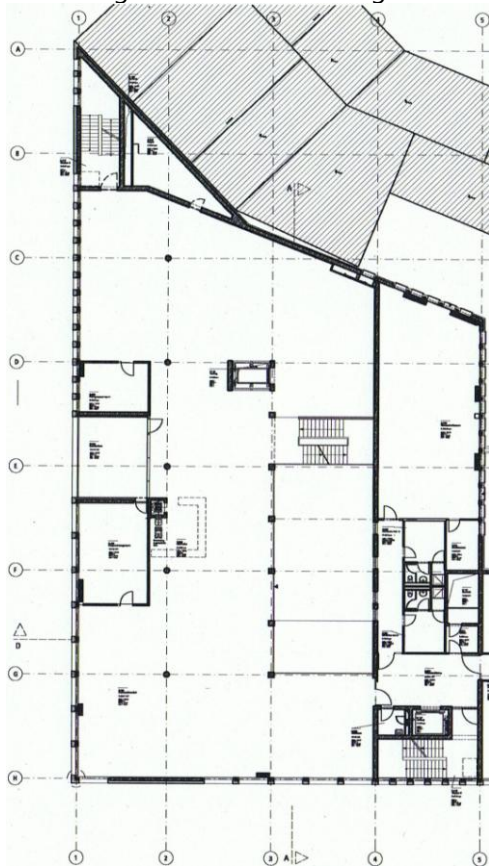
Grundriss 4.Obergeschoss Zentralbibliothek Hamm
